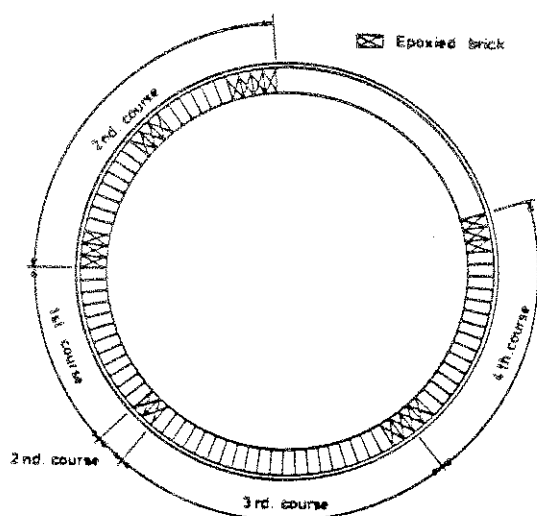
Ausmauerung des Drehofens nach dem Klebeverfahren
